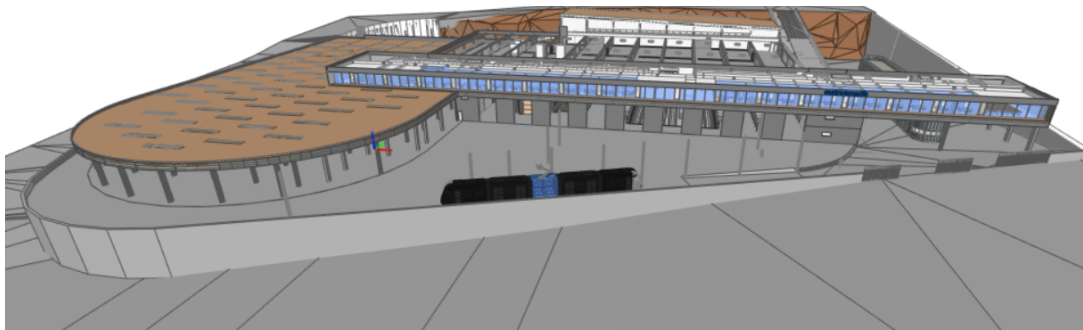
Planta Alta en aplicación BIM Vision Elaboración Propia
